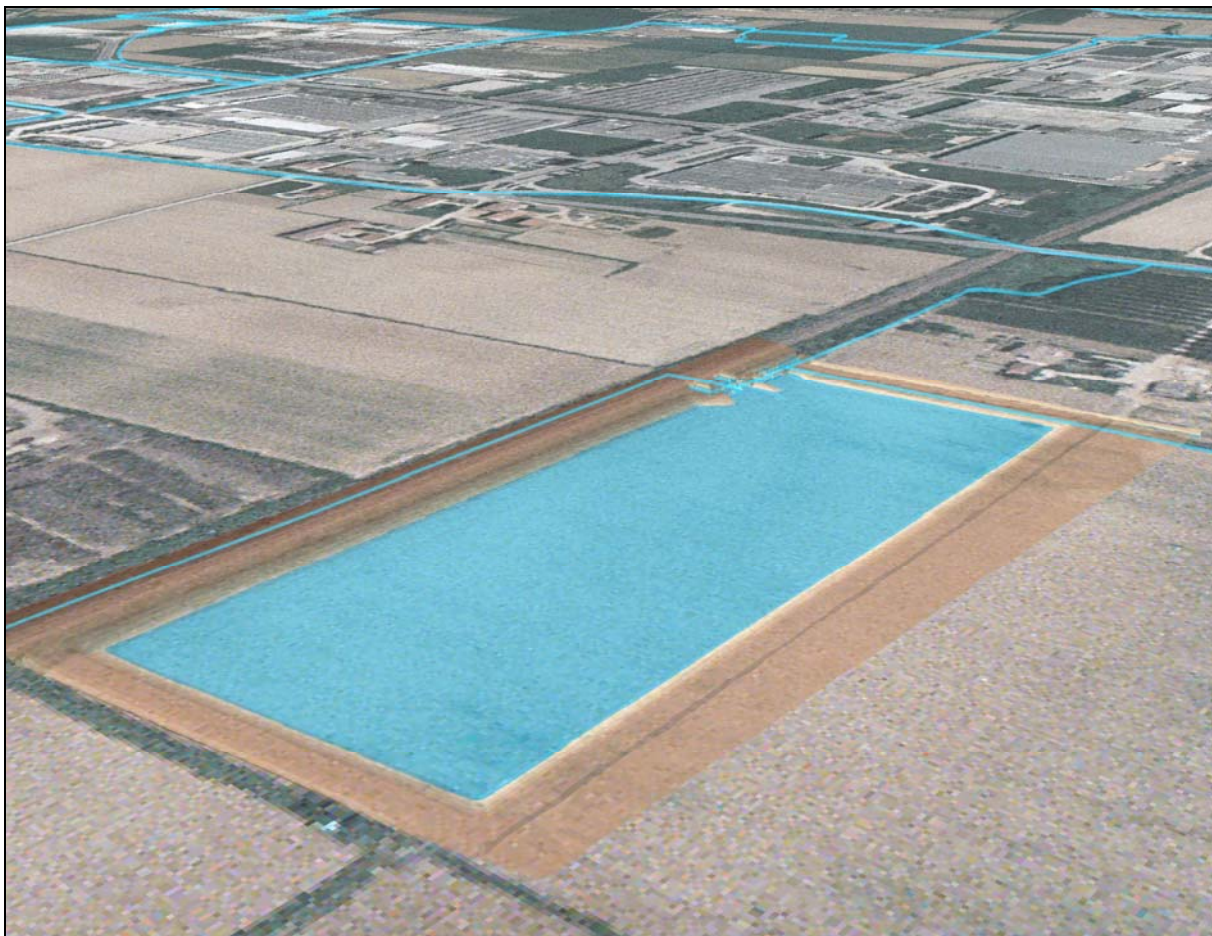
Vista prospettica dell'area di espansione su ortofoto.
